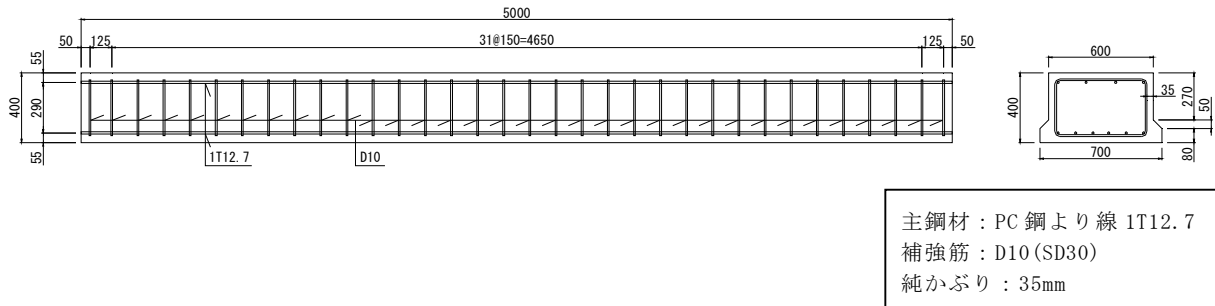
試験体形状（プレテンション方式大型試験体 スラブ型）
